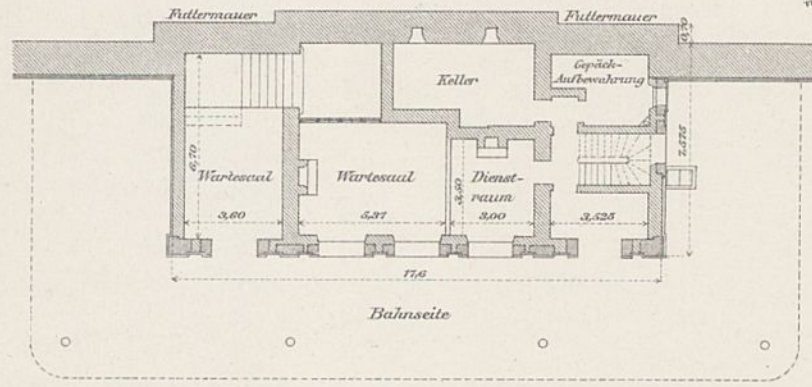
Grundriss in Schienenhöhe. 1:300.
